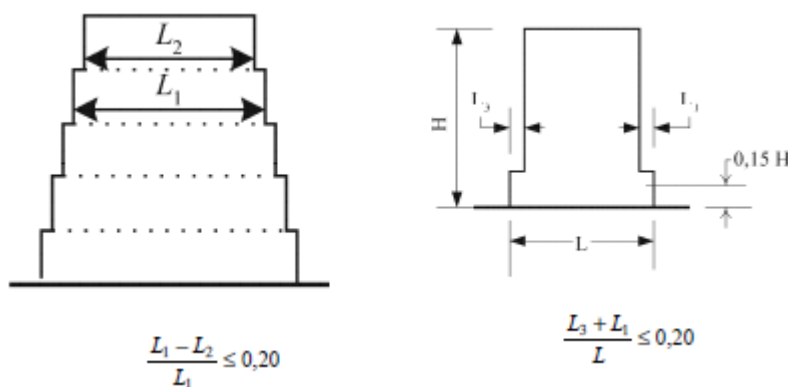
Limitação do recuo a 20% da dimensão em planta do piso inferior.
